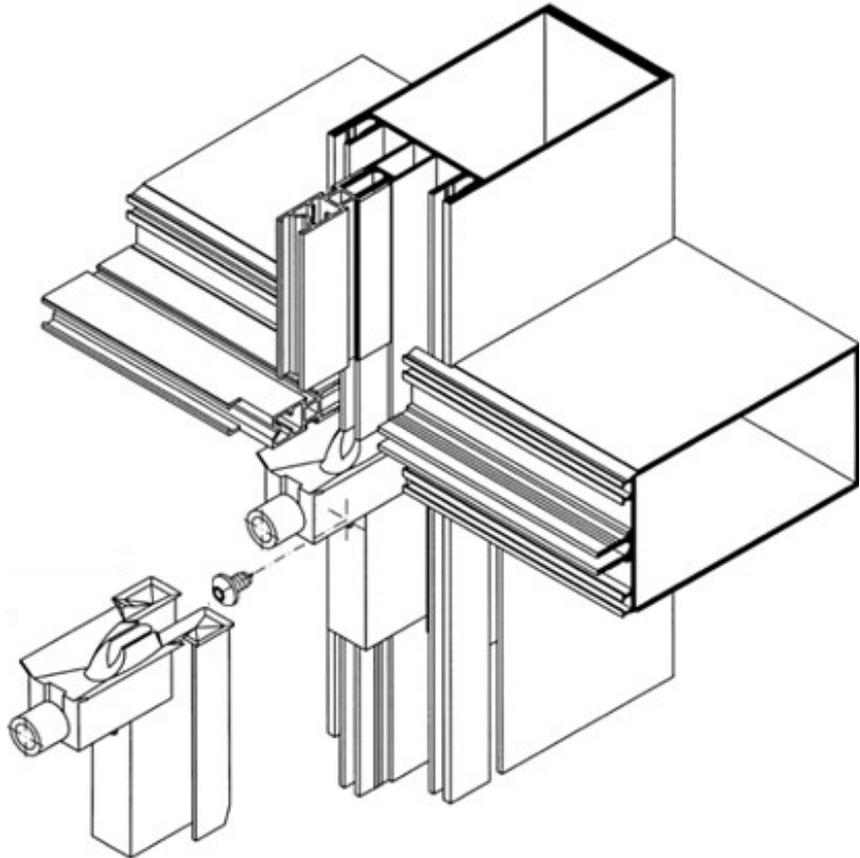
Piezas de desagüe en muro cortina Stick.
